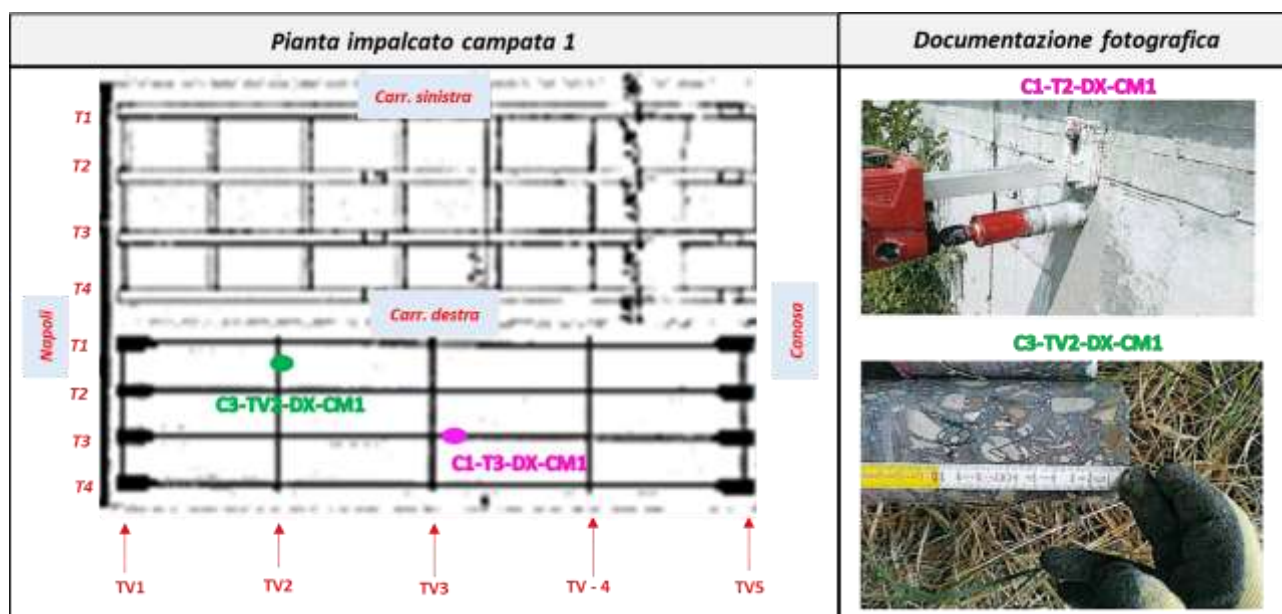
Ubicazione prove in pianta e documentazione fotografica – Prelievo di carote di calcestruzzo
